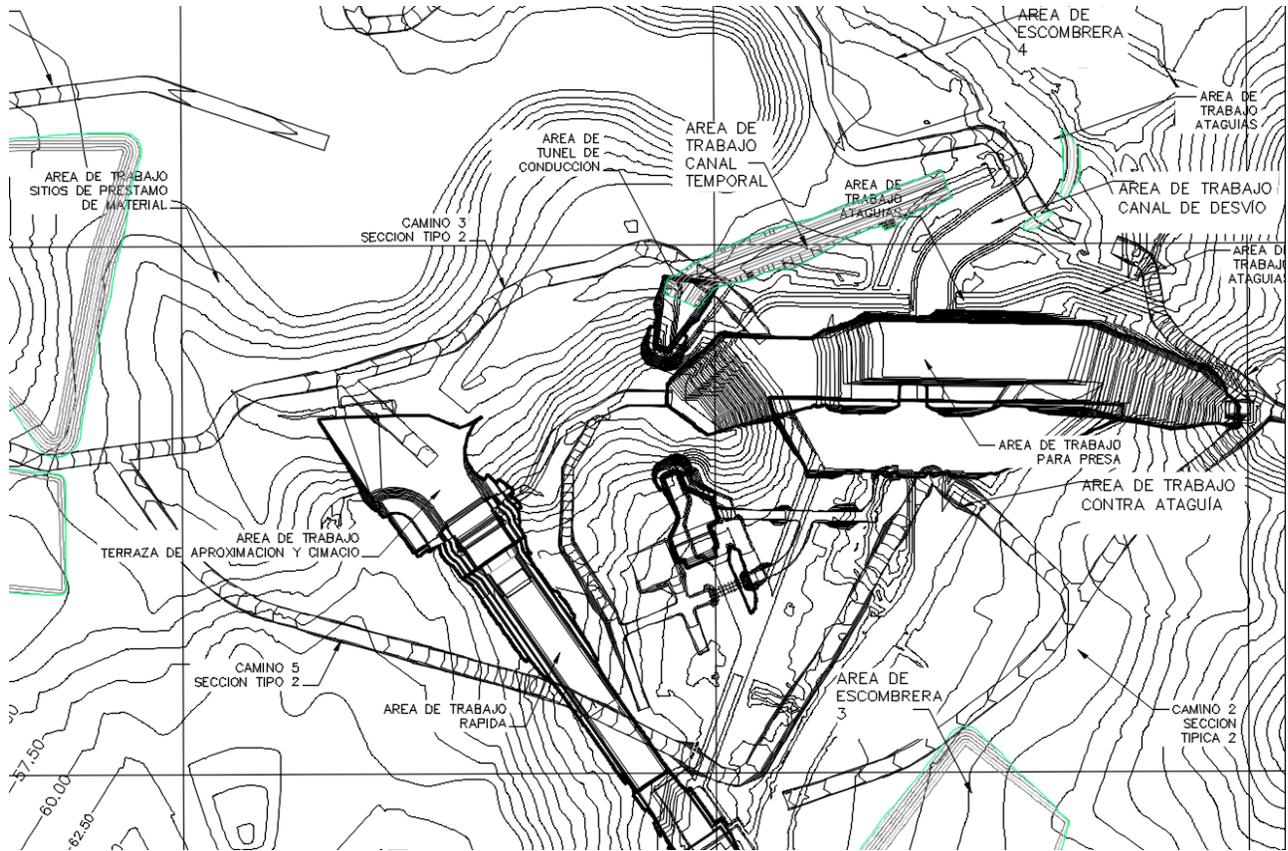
Vista General de Sitios de Extracción y obras para el Embalse Río Piedras.
